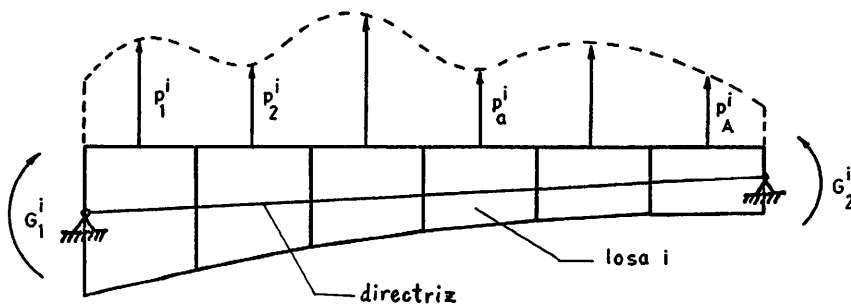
Acciones consideradas en el cálculo longitudinal de una losa genérica
